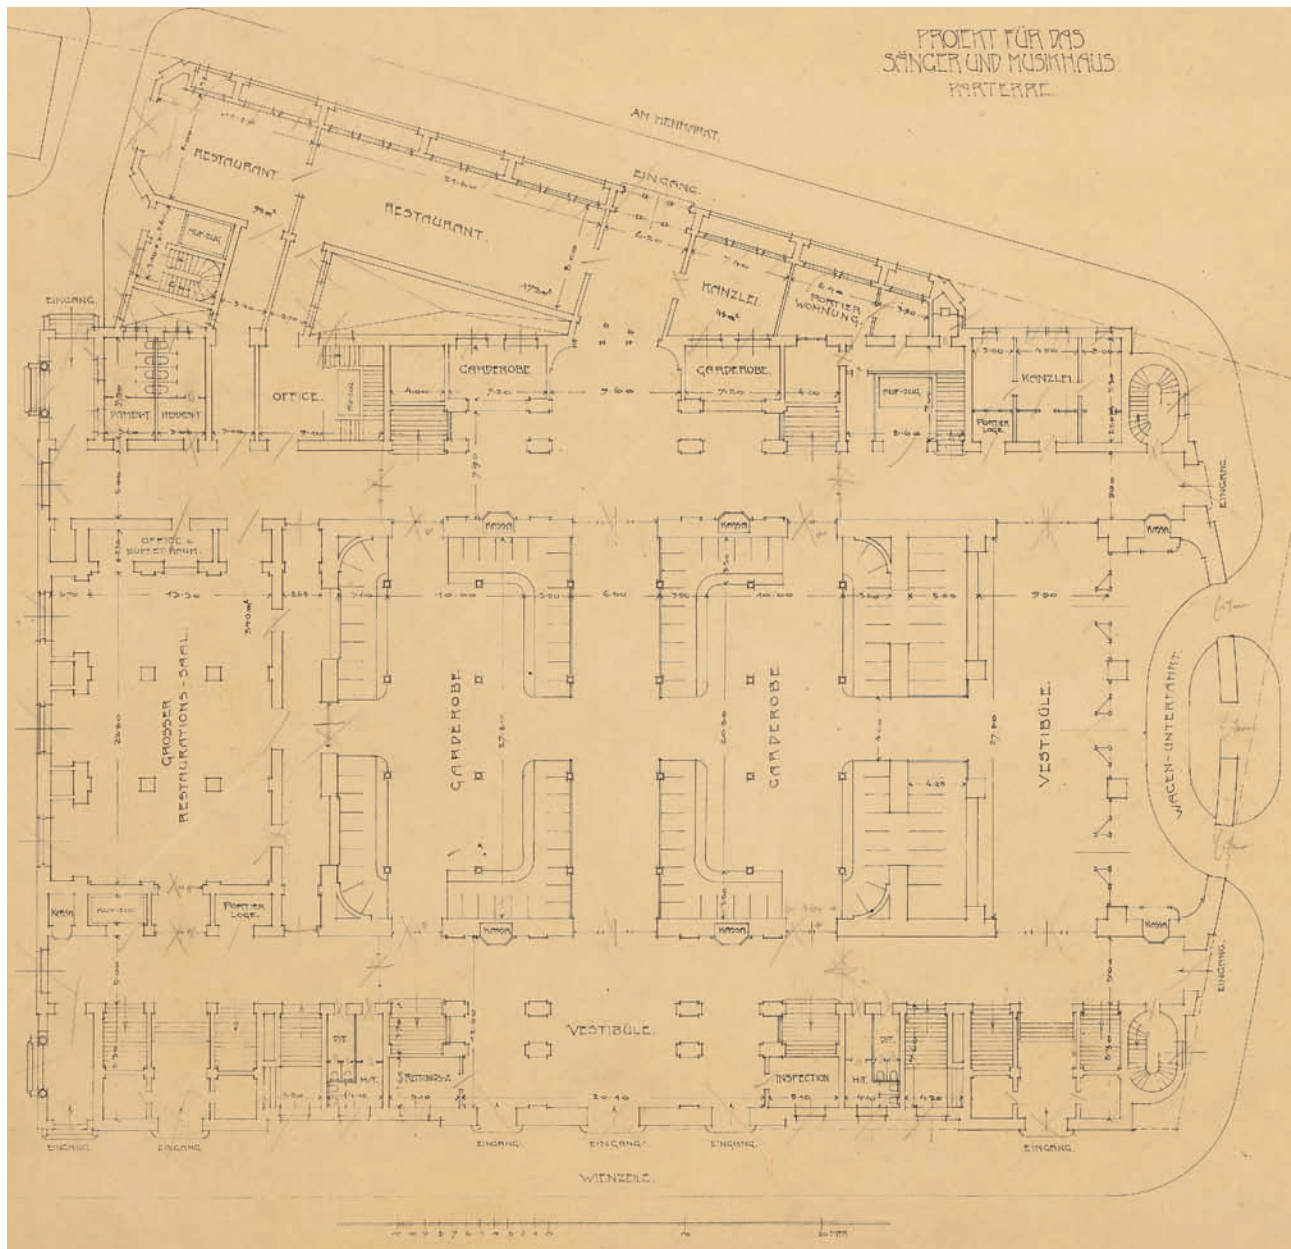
Ludwig Baumann, Projekt eines Musik- und Sängershauses, 1907, Erdgeschoßgrundriss (Wien Museum, Inv.-Nr. 238.049/5).
